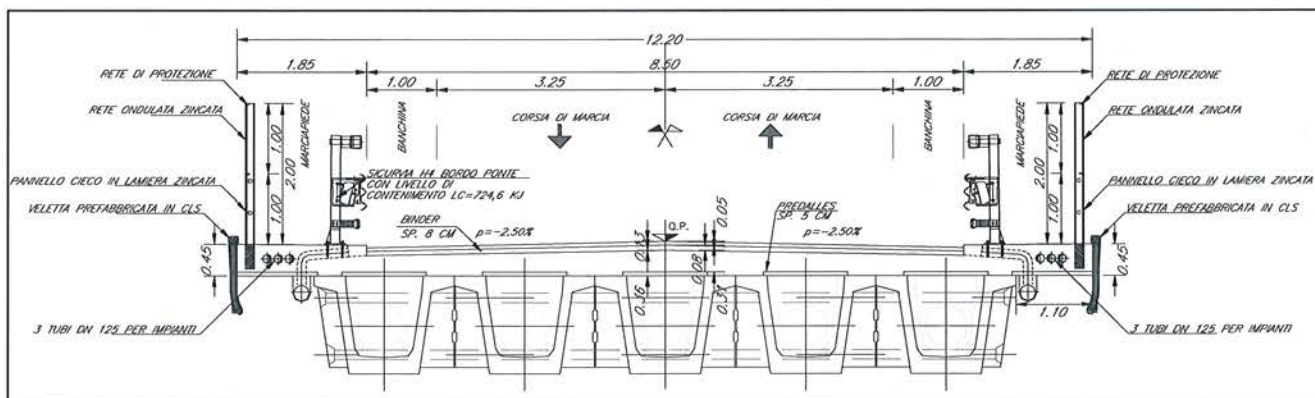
Sezione tipo cavalcaferrovia campata. L=25.00 m
